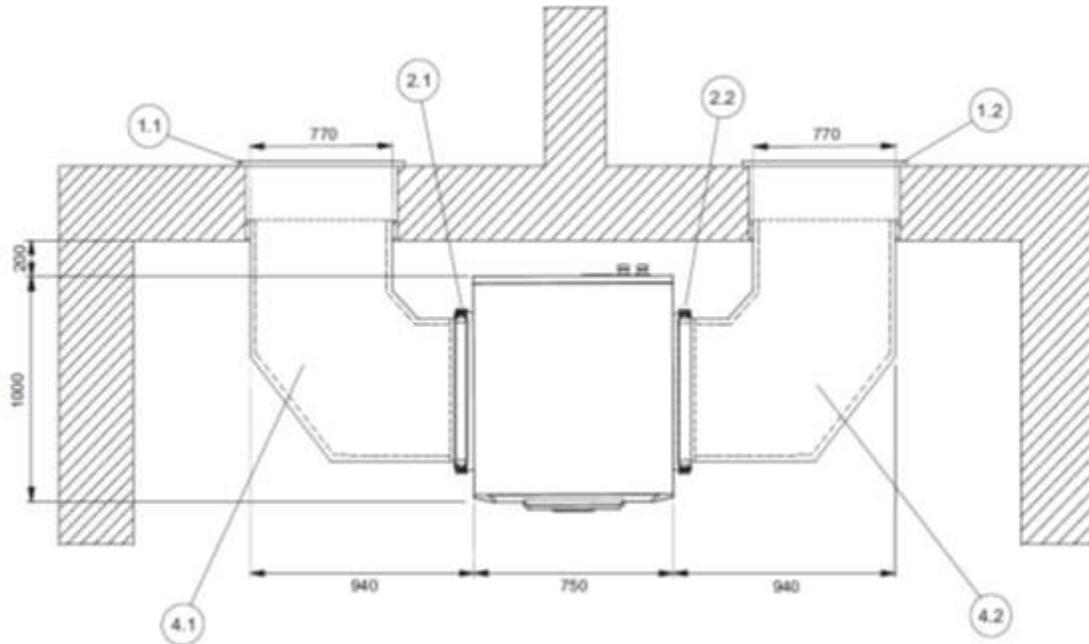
Vista dall'alto - LI 24TES e LI 28TES (installazione a parete con canale aria lato aspirazione e lato scarico)
